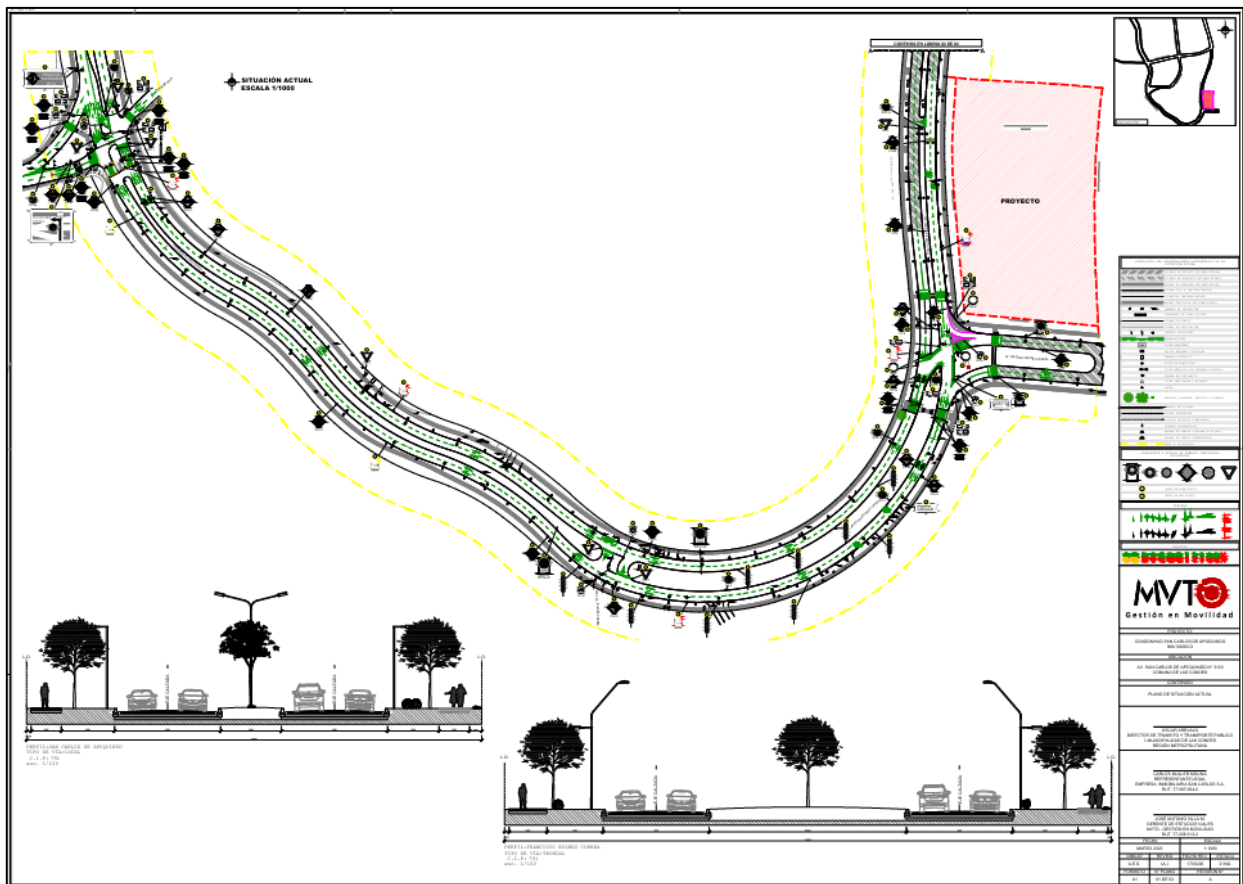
LEVANTAMIENTO PLANIMÉTRICO SITUACIÓN ACTUAL "CONDOMINIO SAN CARLOS DE APOQUINDO".
